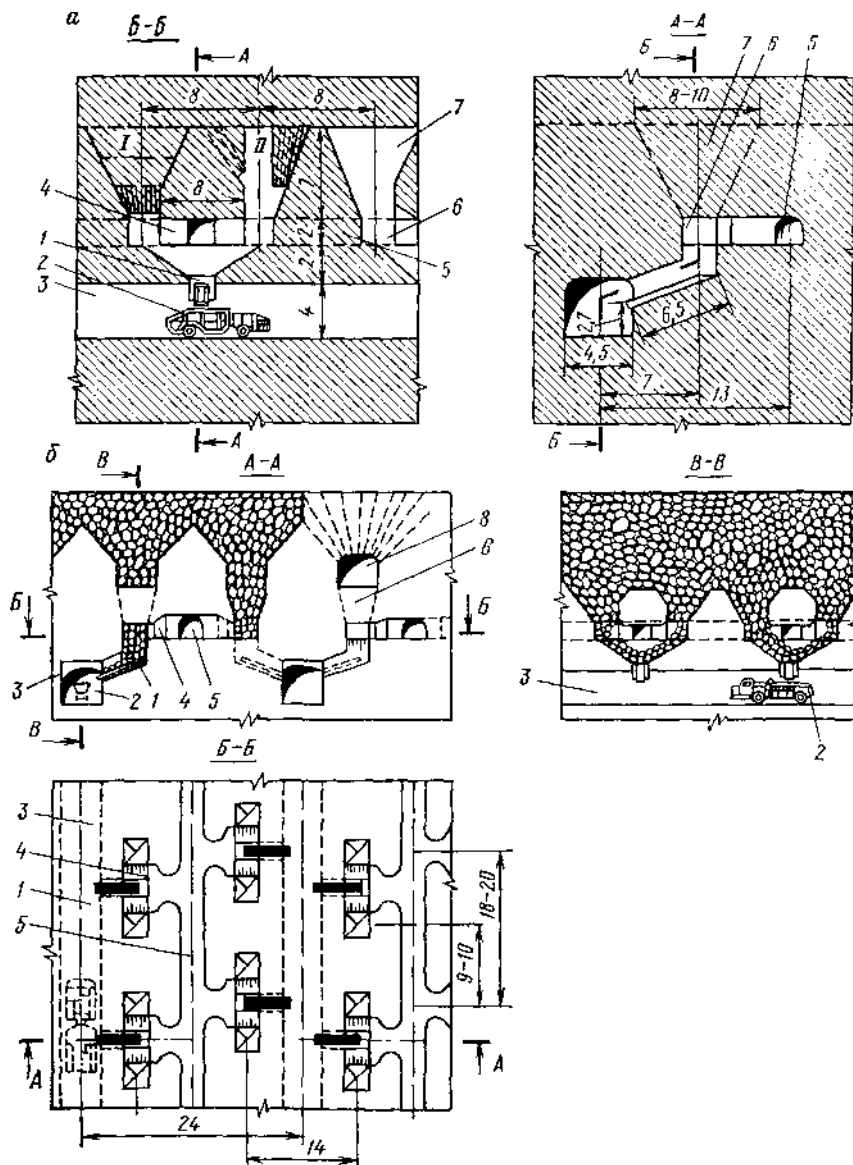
Схемы установки вибропитателя с боковой загрузкой:
